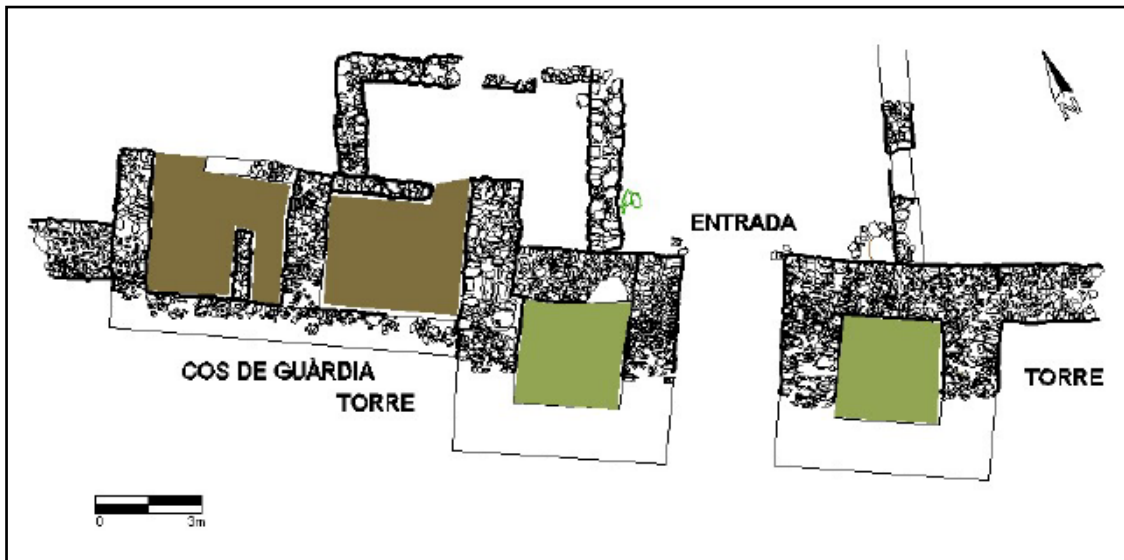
Planta amb les estructures de la nova entrada republicana (Morera, J., 2017:856).
